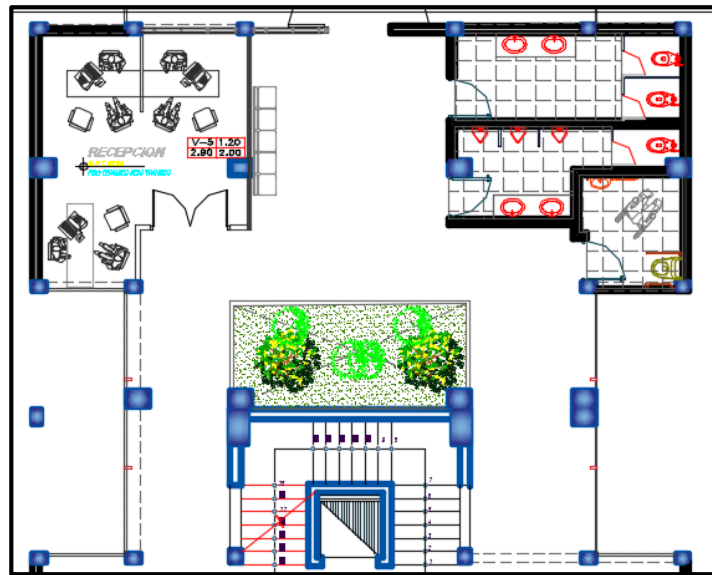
Vista en planta de Recepción y SS.HH, Primer nivel del Bloque "B-01".
